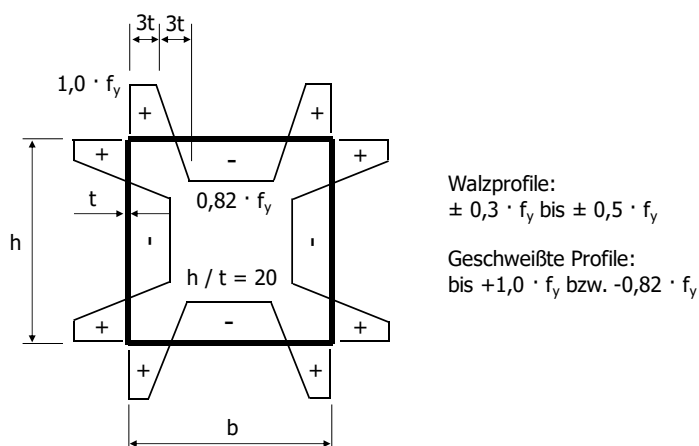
Eigenspannungsverlauf am geschweißten Hohlprofilquerschnitt mit dicken Schweißnähten [31]
